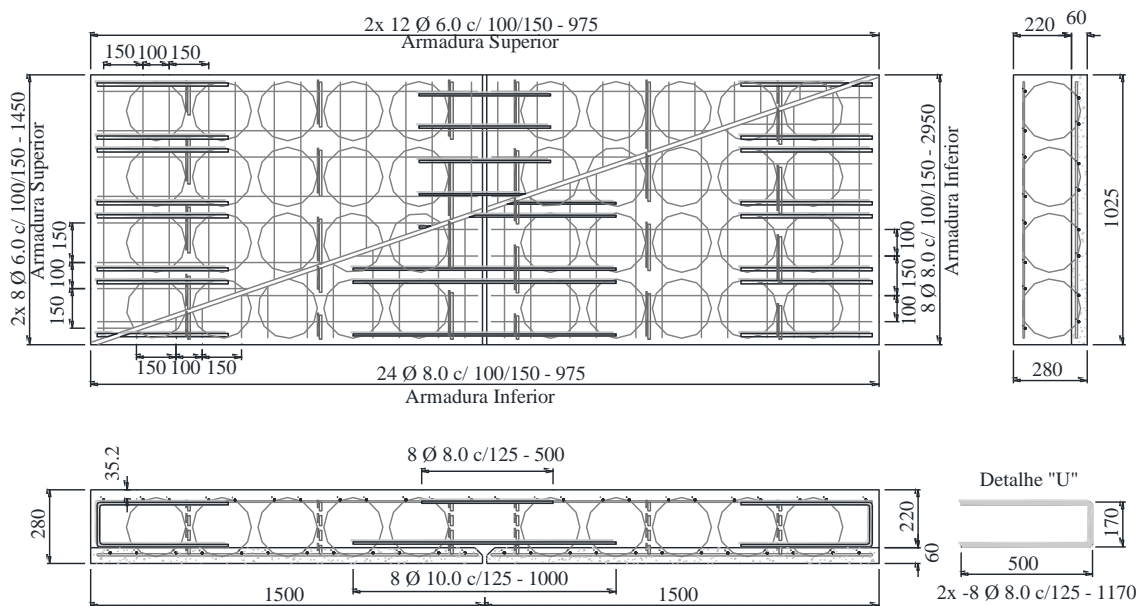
Detalhamento das armaduras de flexão da laje BD28-F3 (dimensões em mm).
